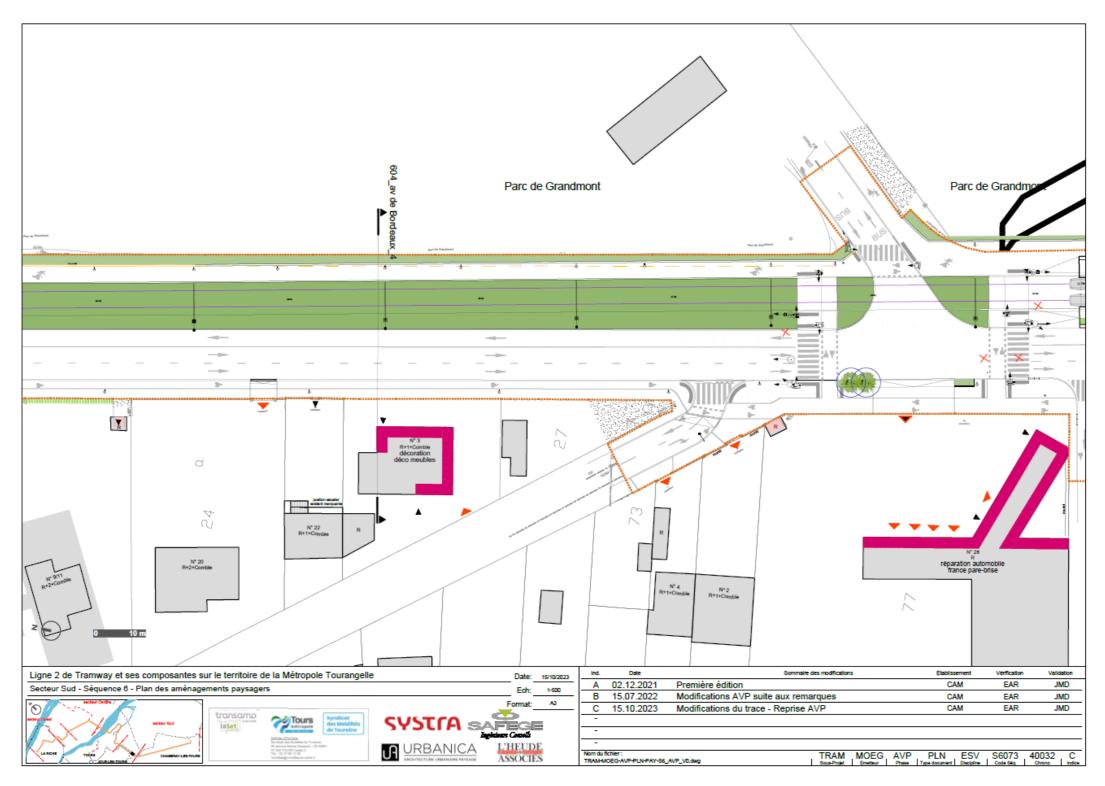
plan masse de localisation des arbres à abattre sur avenue de Bordeaux (planche 1)
